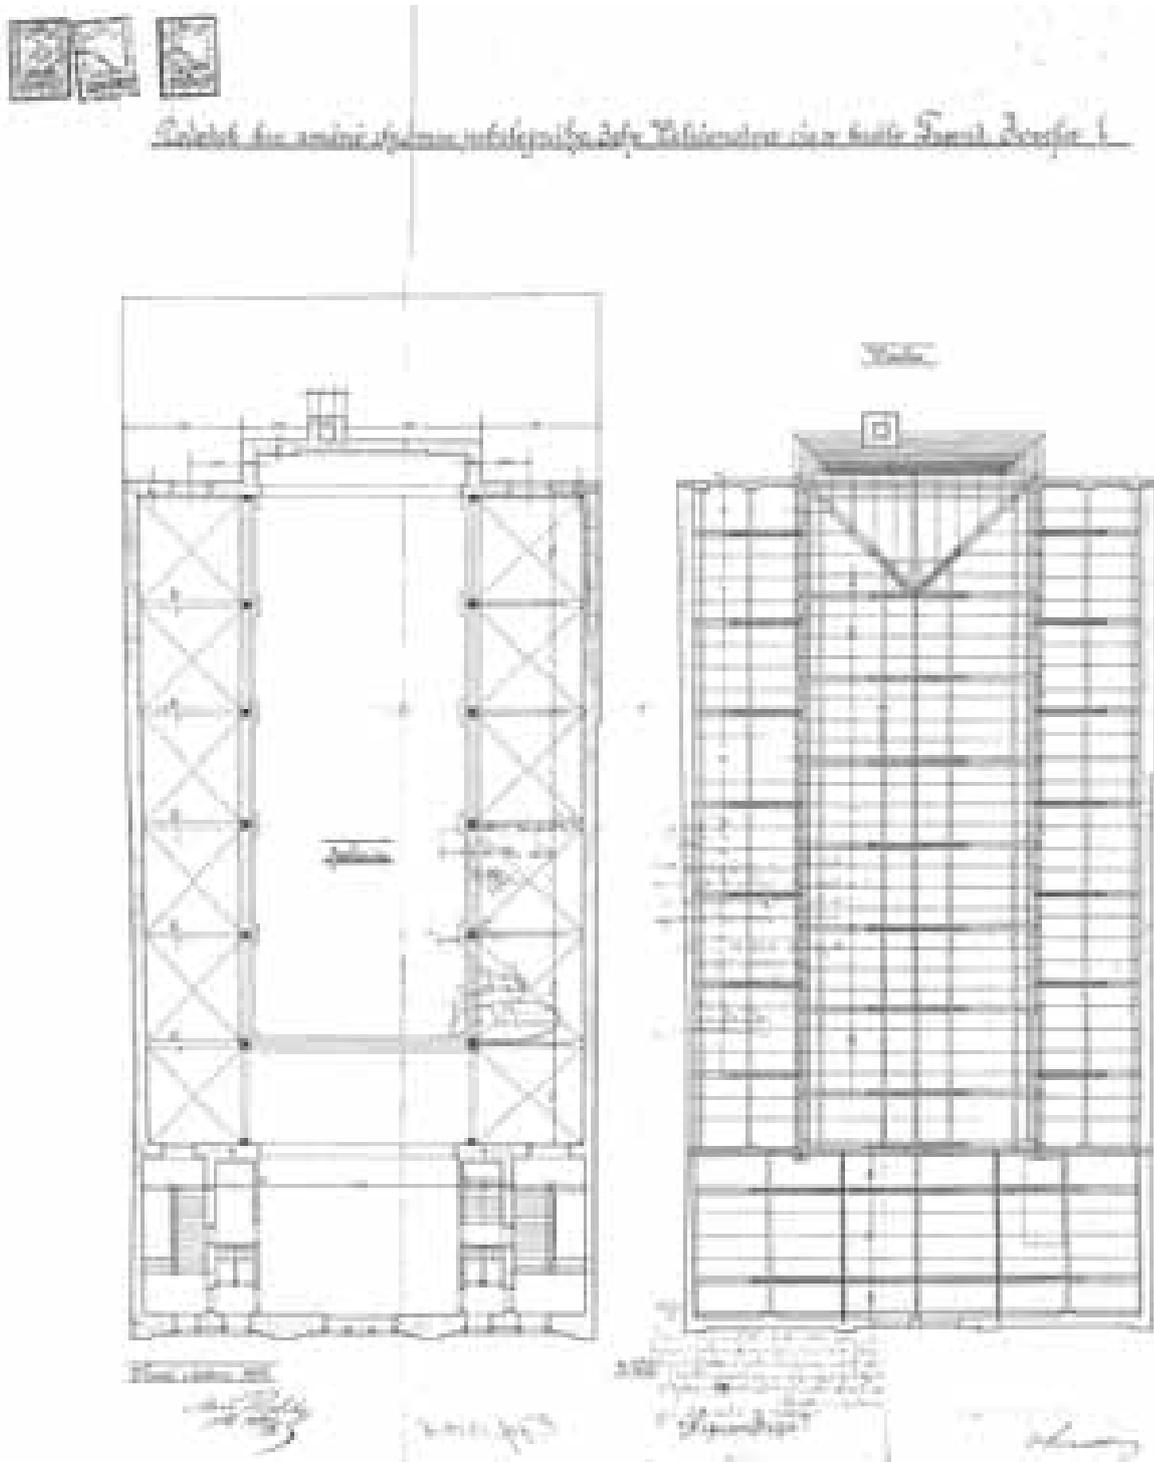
Grundriss des Synagogenprojekts von Alois Richter (Galerie und Dachstuhl), Mai 1900.
